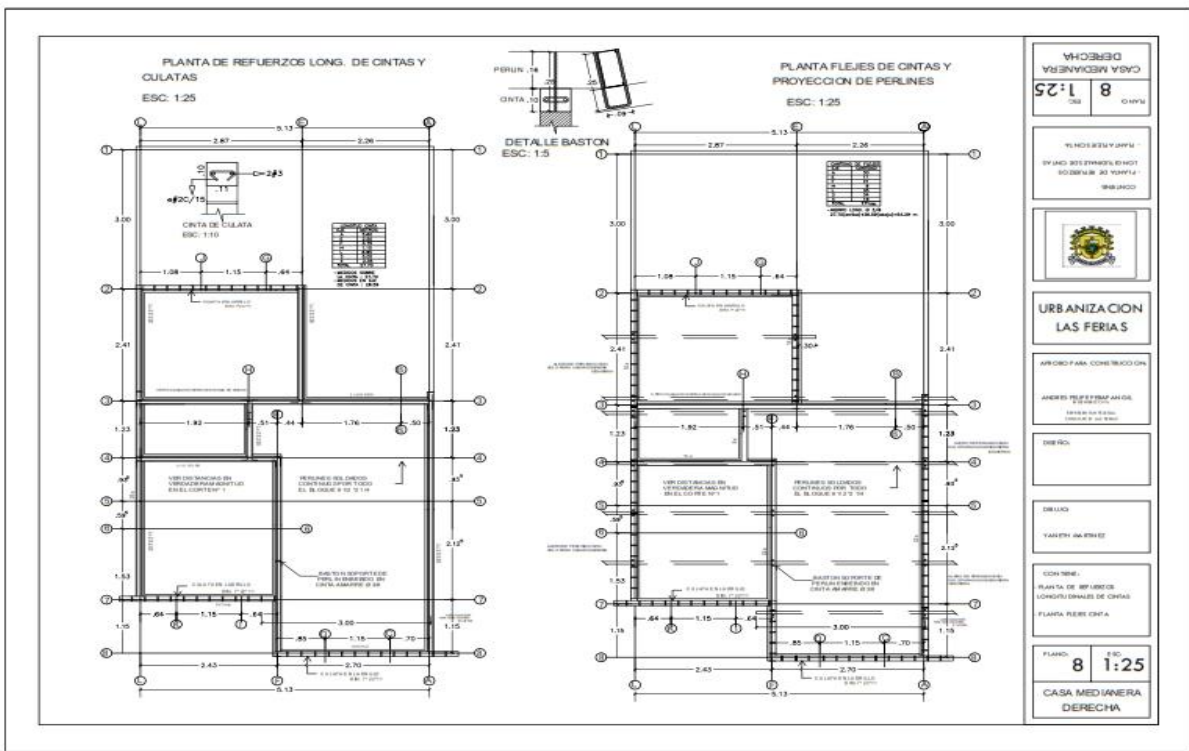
Planta de refuerzos longitudinales de cintas, flejes cintas.
